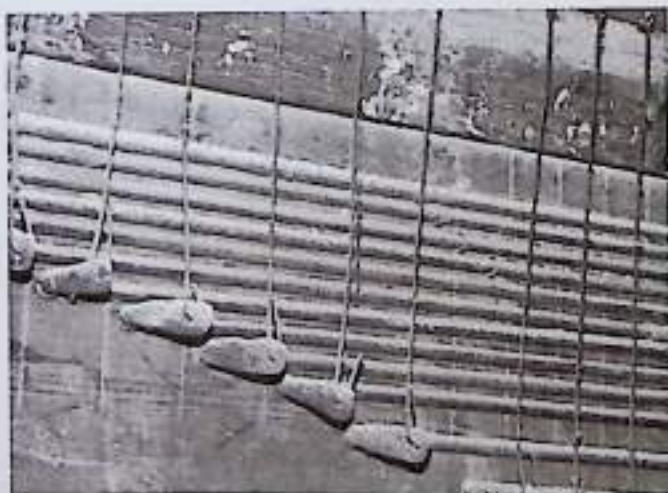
Chiesa del S. Pietro detta del Purgatorio.
